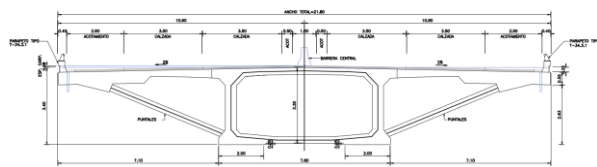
Sección transversal de la tipología con tablero empujado, proyecto de Mexpresa.
